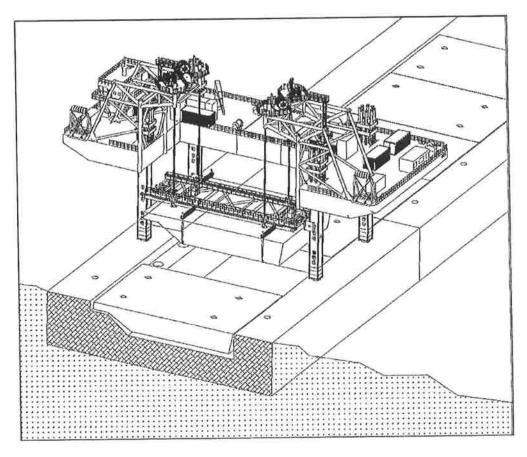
VISTA 3D DEL JACK-UP IN FASE DI MOVIMENTAZIONE PARATOIA
